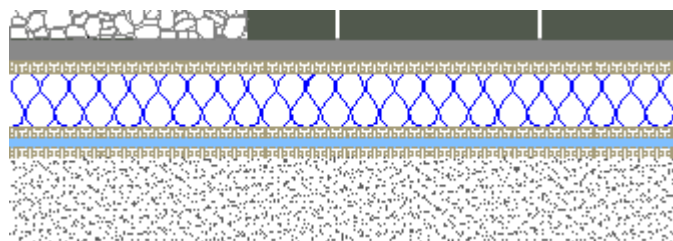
Aplicação de impermeabilizações e isolamento térmico em coberturas invertidas
